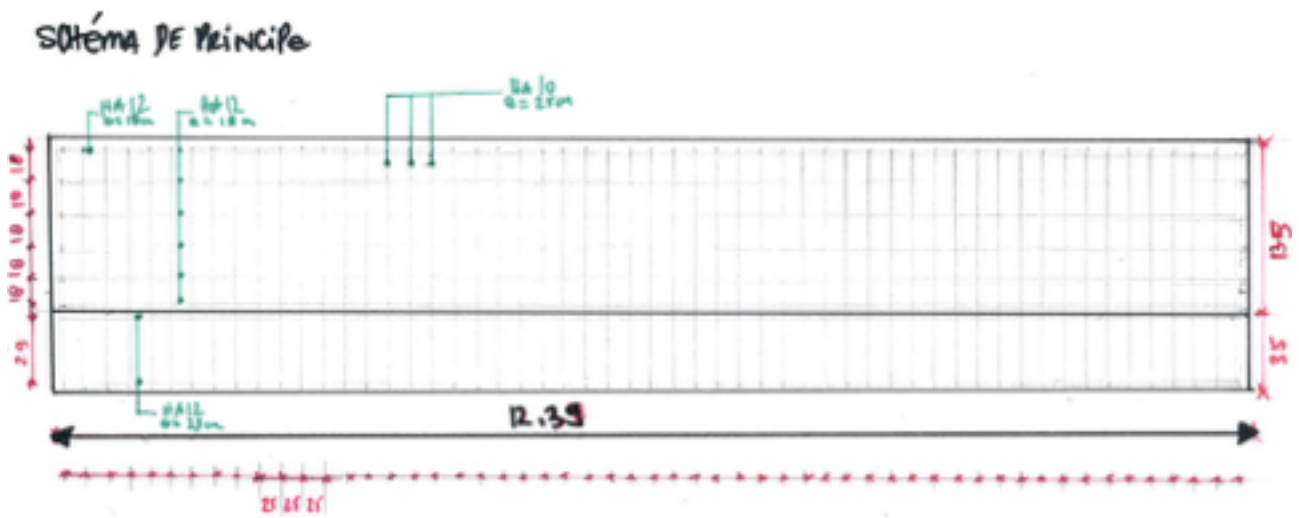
Principe de ferrailage du muret - Coupe longitudinale
